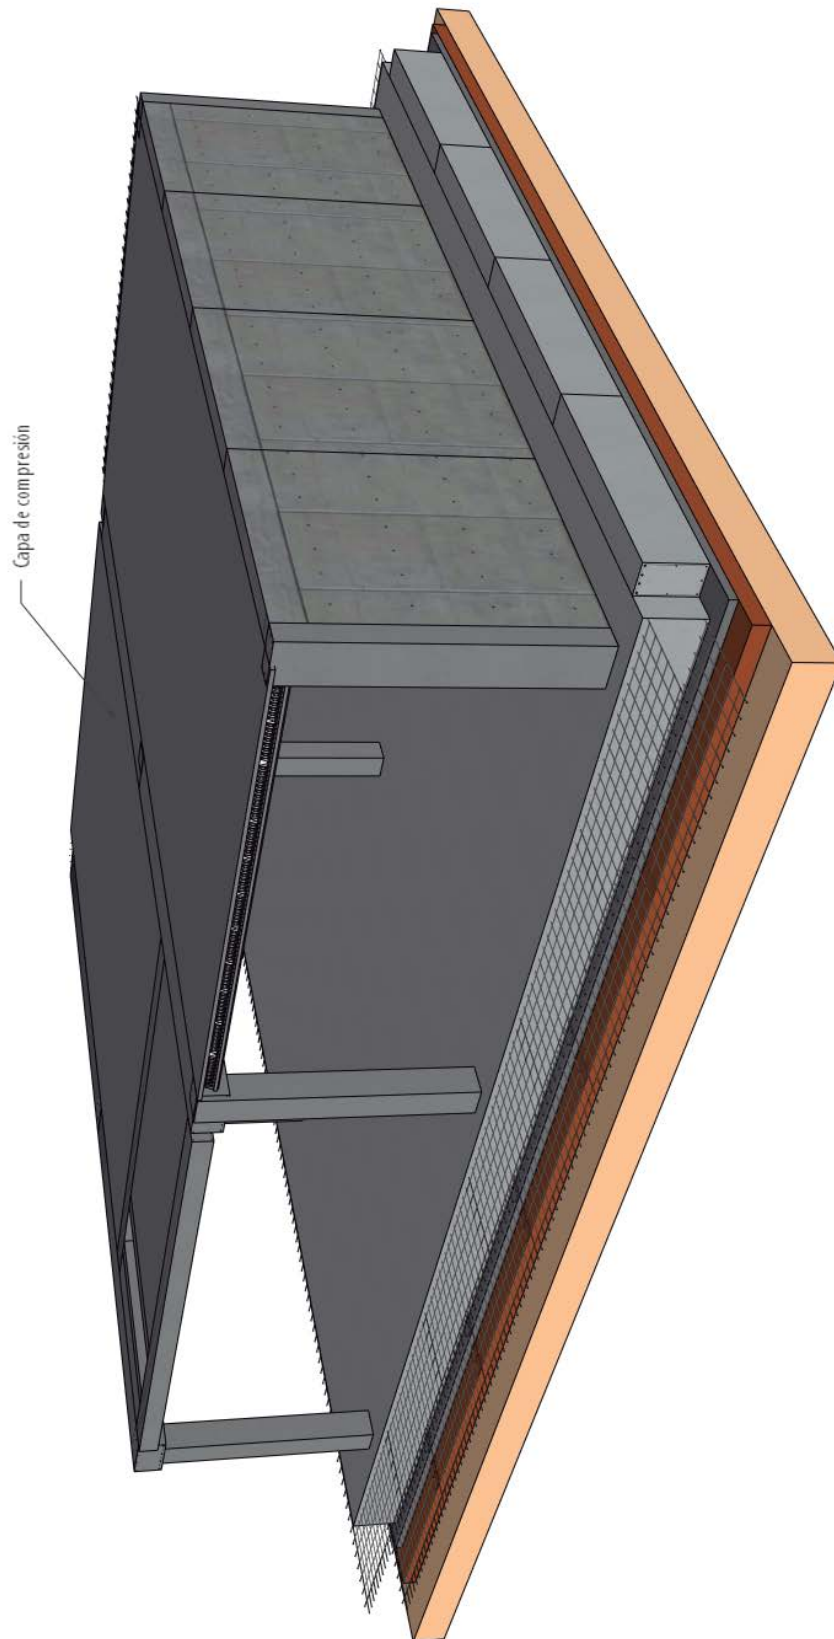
Hormigonado de las prelasas del forjado del sótano
